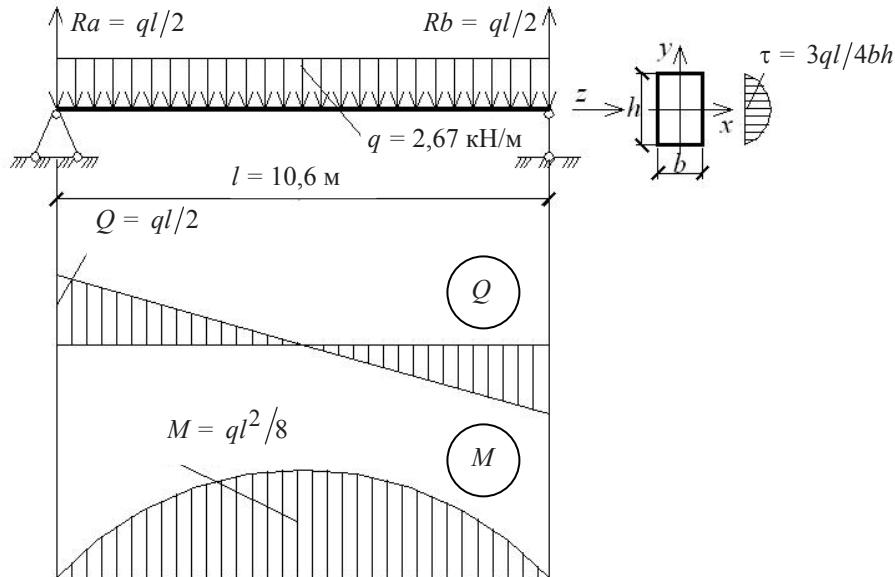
Расчетная схема продольной балки с эпюрами сил
